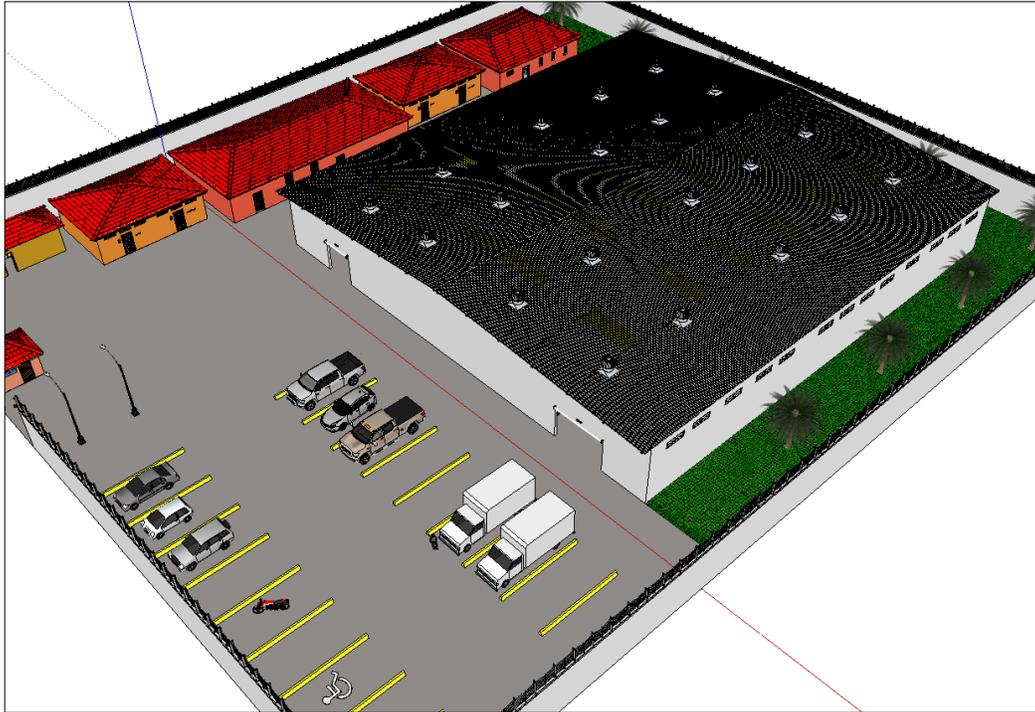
Perspectiva General 3D de la Planta Propuesta
